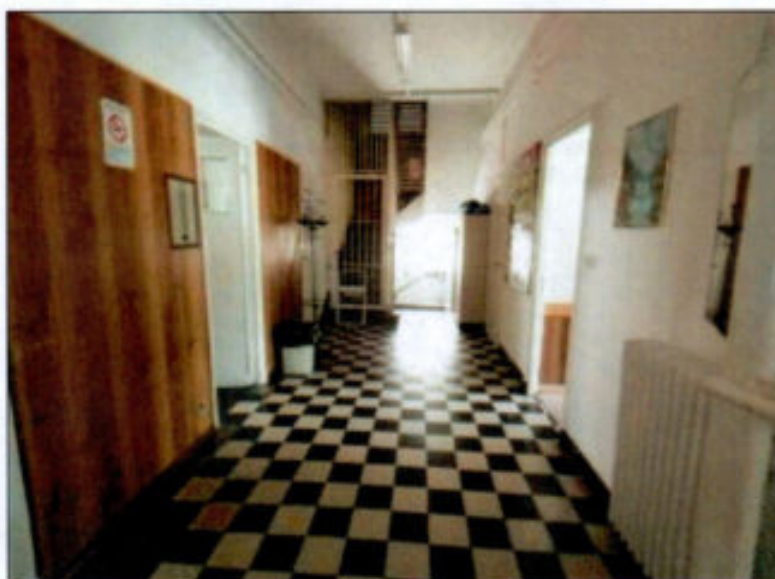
Vista del corridoio interno con pavimentazione in quadrette di graniglia
